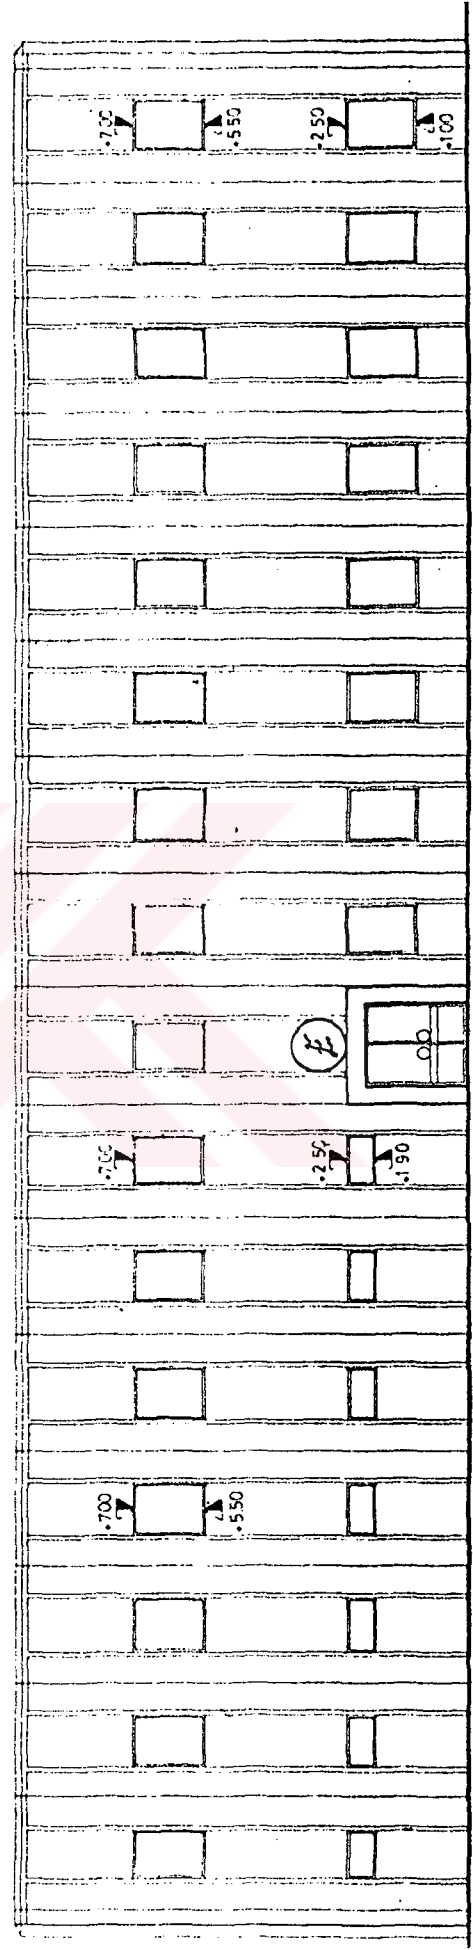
Eltaf Tekstil 1. Kat Planı.
